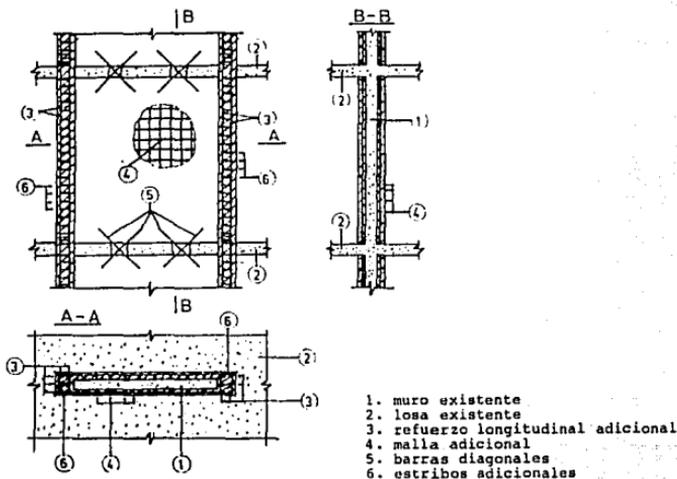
Continuidad del refuerzo en muros de concreto.
